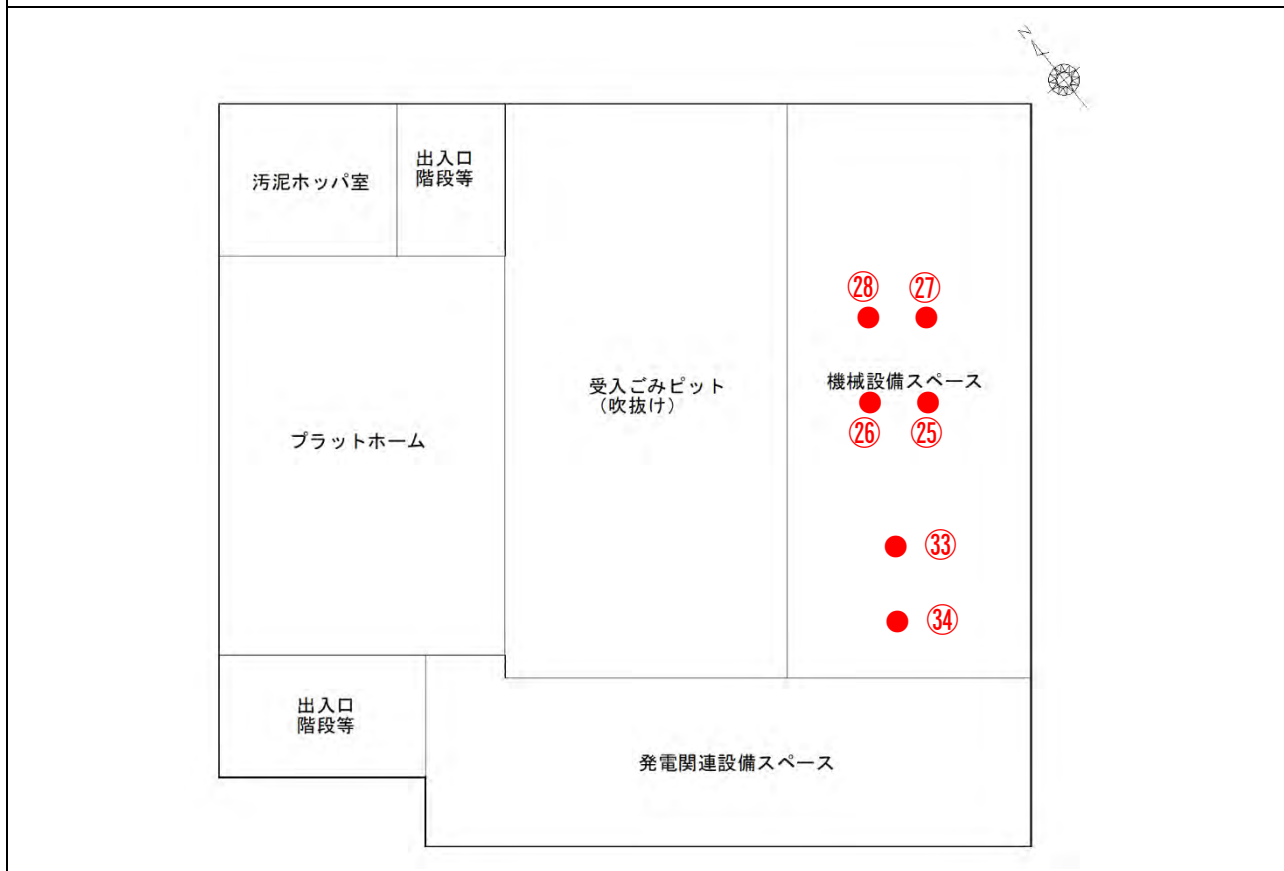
(2) 廃棄物受入棟平面図 (1階)
